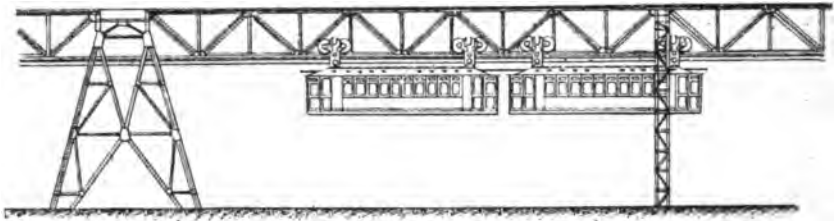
Voie sur arceaux (coupe longitudinale).
